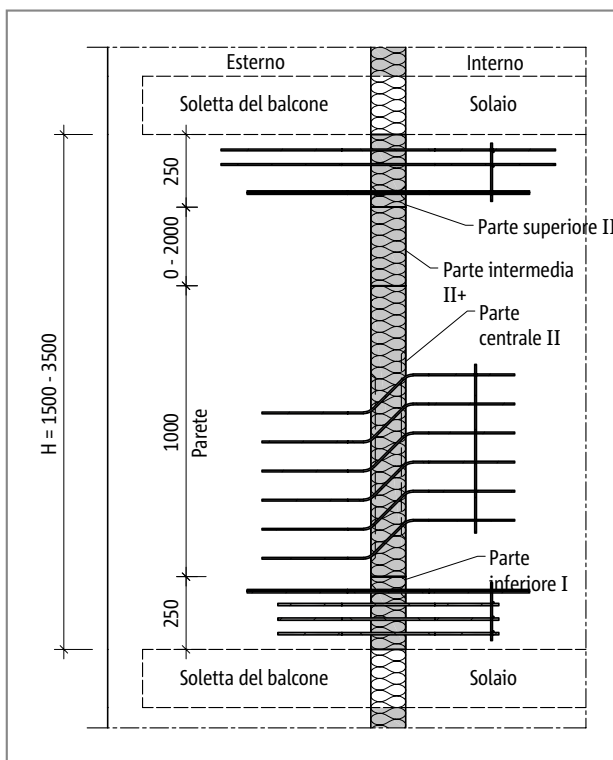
Schöck Isokorb® tipo WXT: balcone con lastre delle pareti portanti e termoisolate
